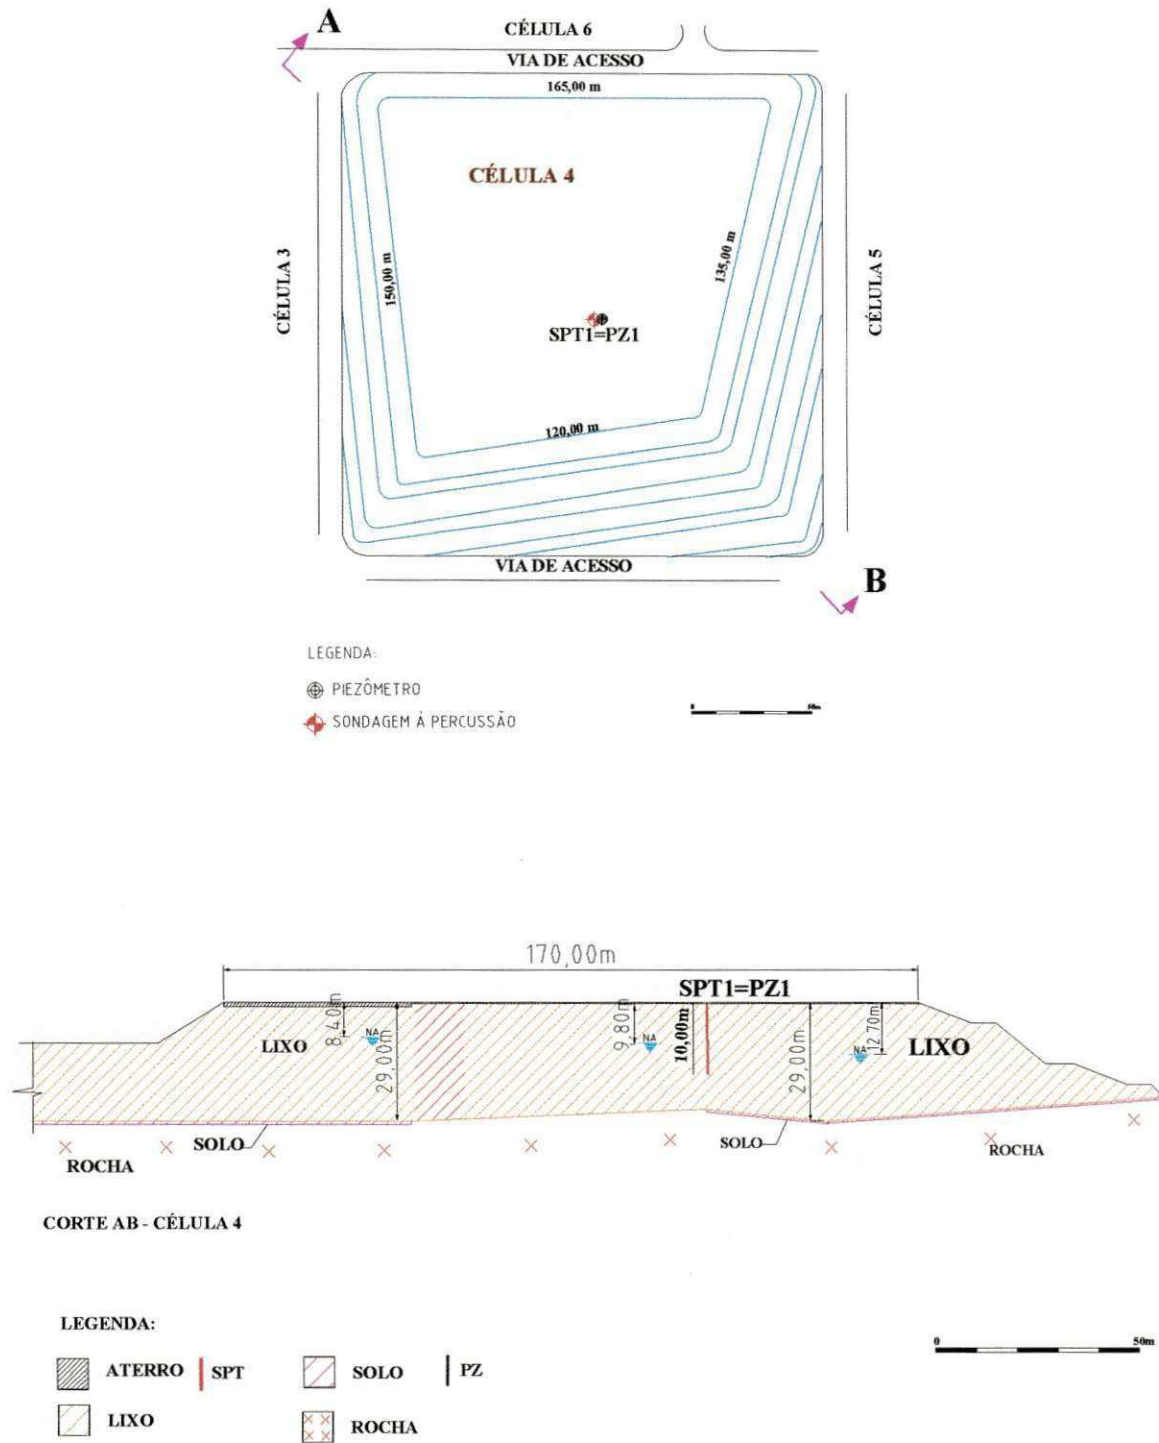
Localização e perfil do piezômetro Pz-1 instalado na Célula 4 no Aterro da Muribeca – Jaboatão dos Guararapes (PE)
